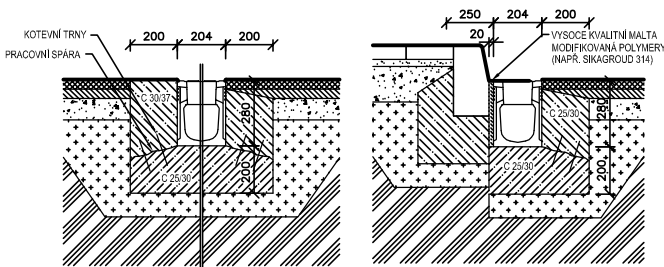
DETAIL INSPEKČNÍHO KUSU DM 1500.R
